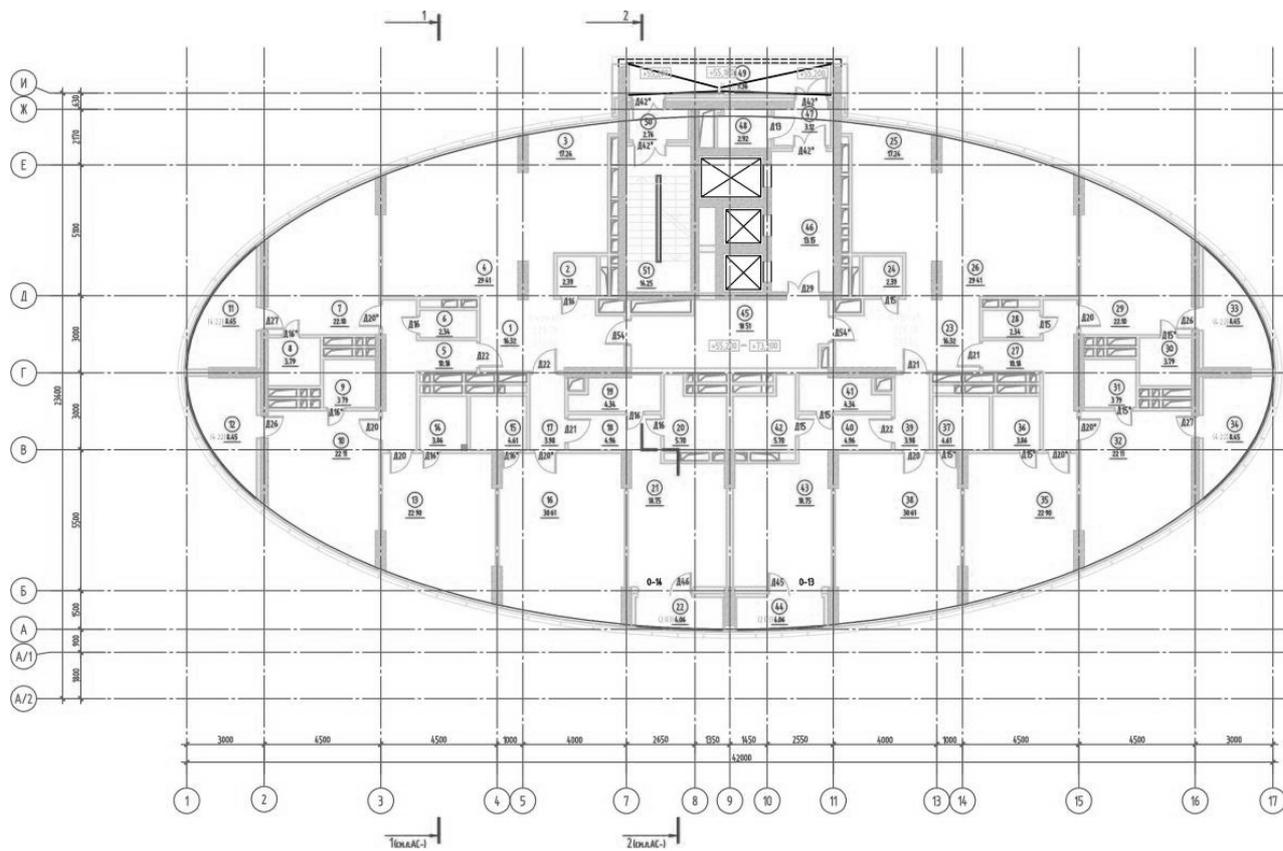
План первого этажа высотной части здания, к примеру мониторинга в г. Казани
